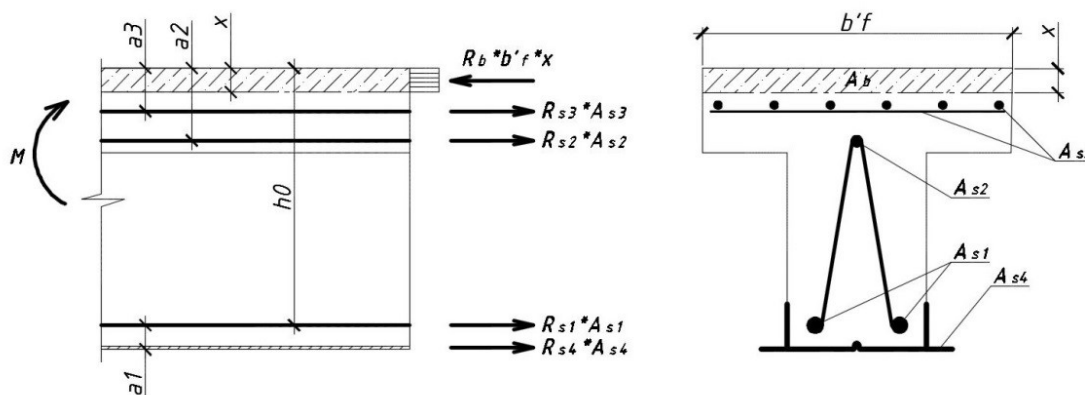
Расчетная схема усилий в нормальном сечении изгибаемого железобетонного элемента при его расчете по прочности
